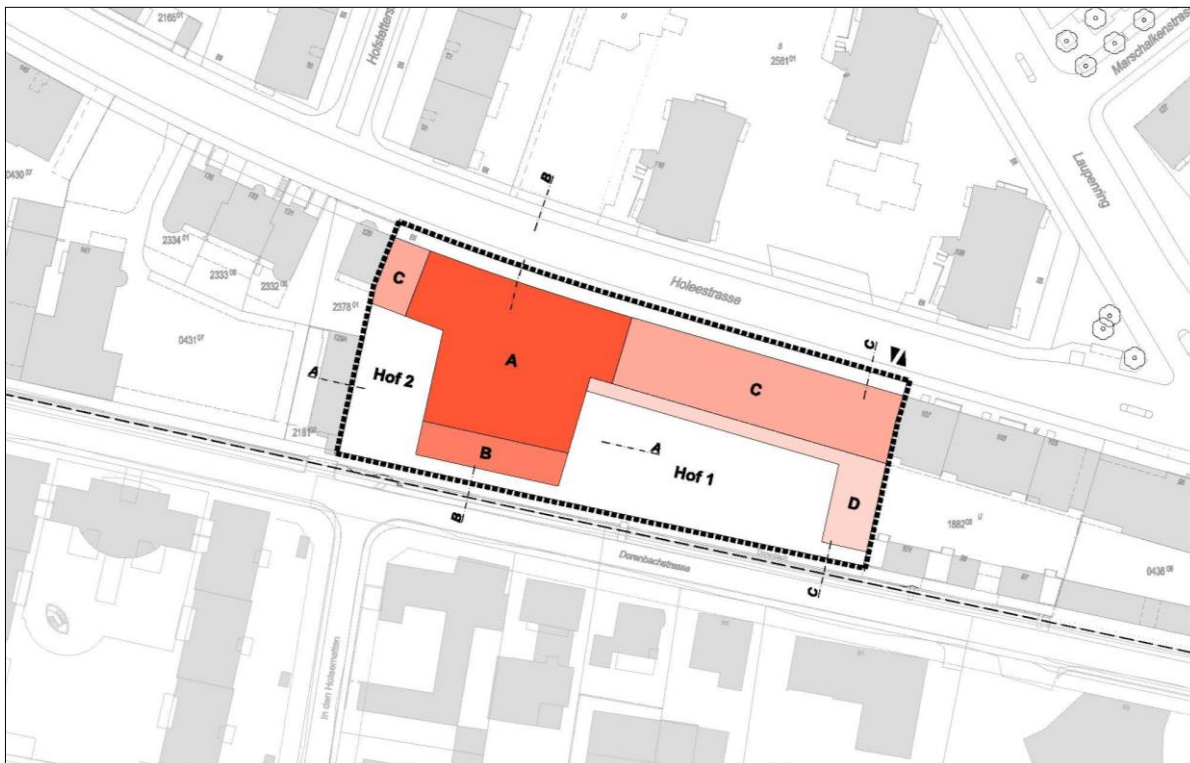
Bebauungsplan. Plan Nr. 13'934 (Ohne Massstab, Plan genordet)
